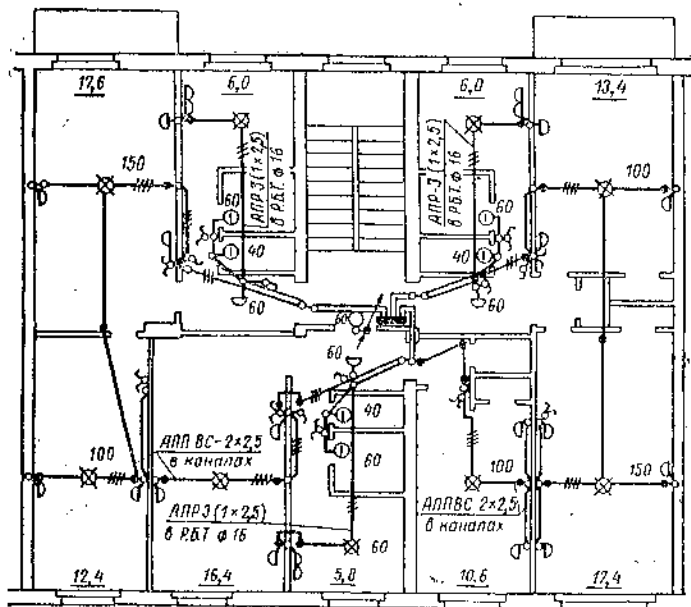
План групповой сети жилого дома. Проводка выполнена скрыто в коробах, штрабах и каналах с учетом возможности замены проводов
